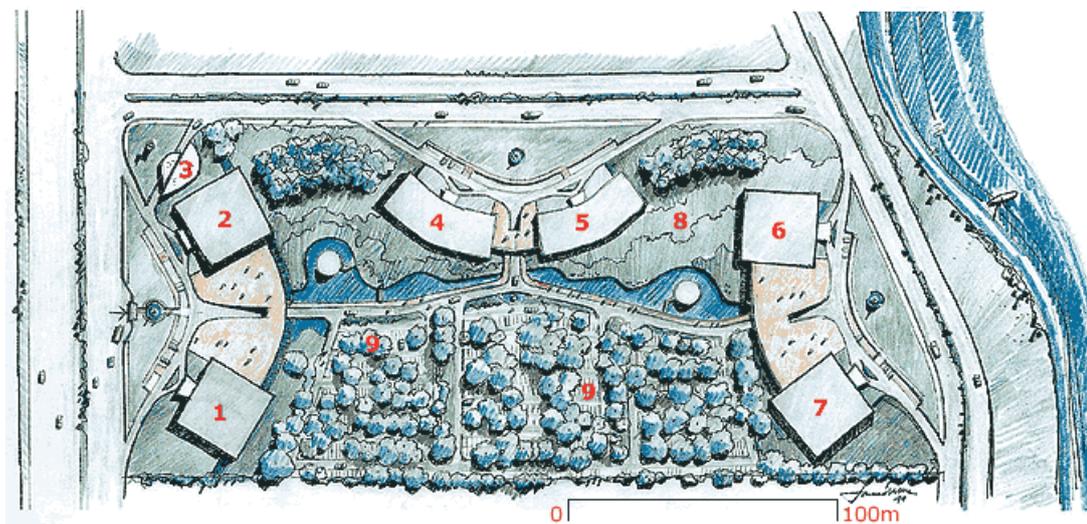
Planta de Situação do Centro Empresarial Mário Henrique Simonsen
